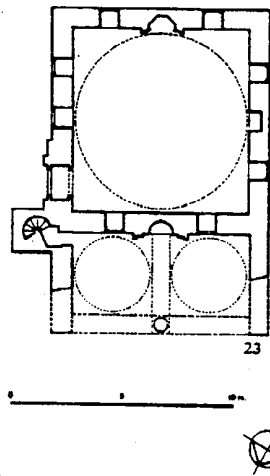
مسقط أفقى لجامع بايزيد يلدريم
